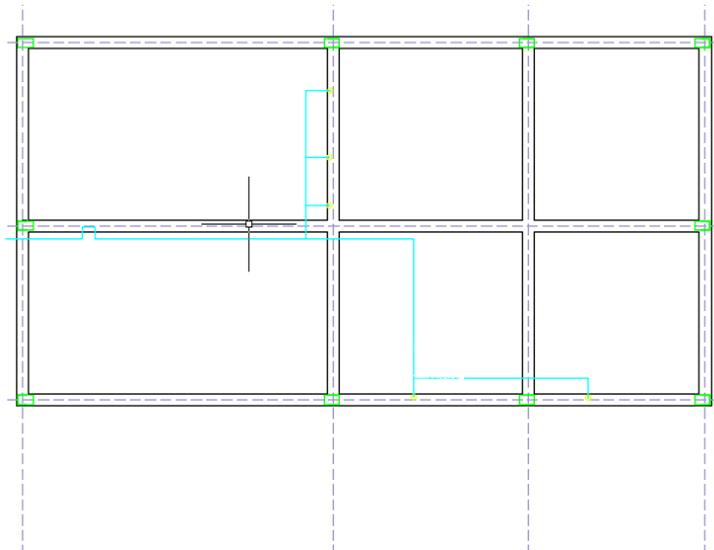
Plano Arquitectónico Fuente: Elaboración propia
